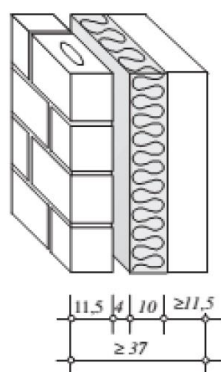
Tipo corrente de parede em tijolo com face à vista [17]
